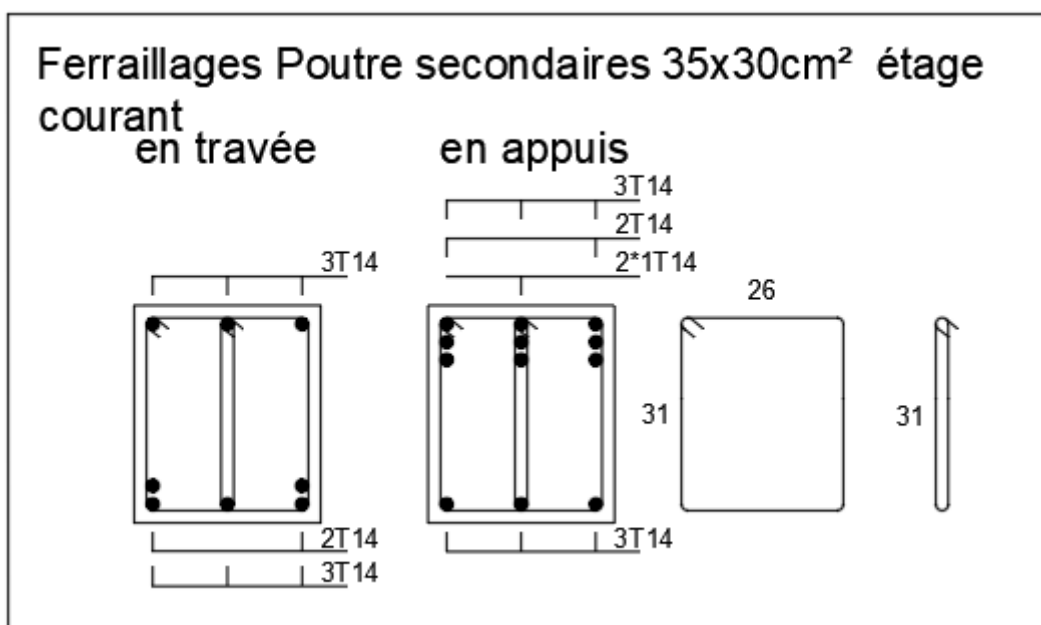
Ferrillages poutre secondaires étage courant.
